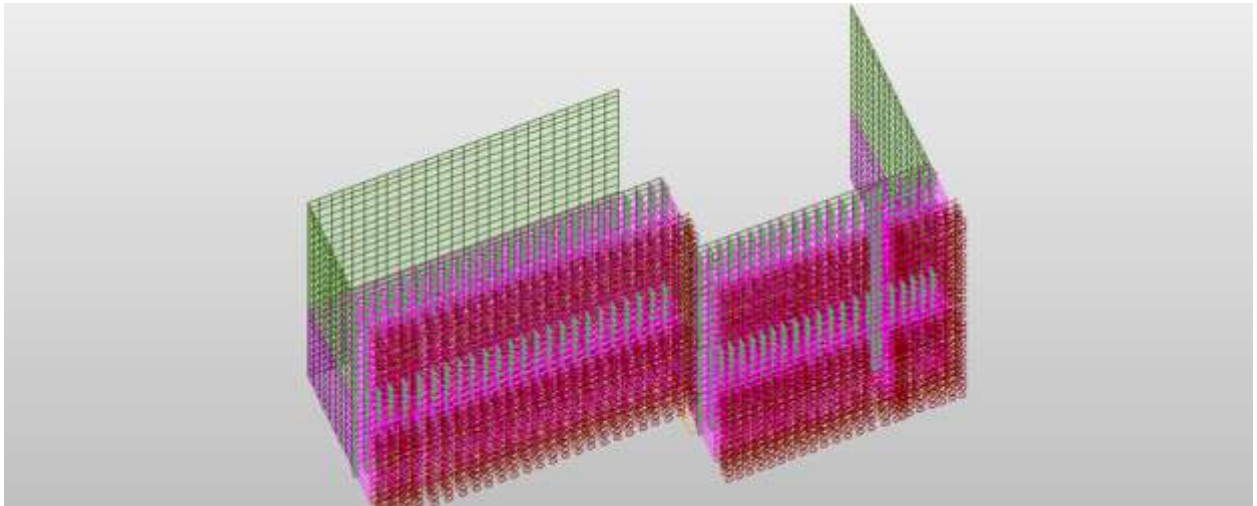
Assegnazione incremento dinamico spinta terre – wood in direzione +Y
